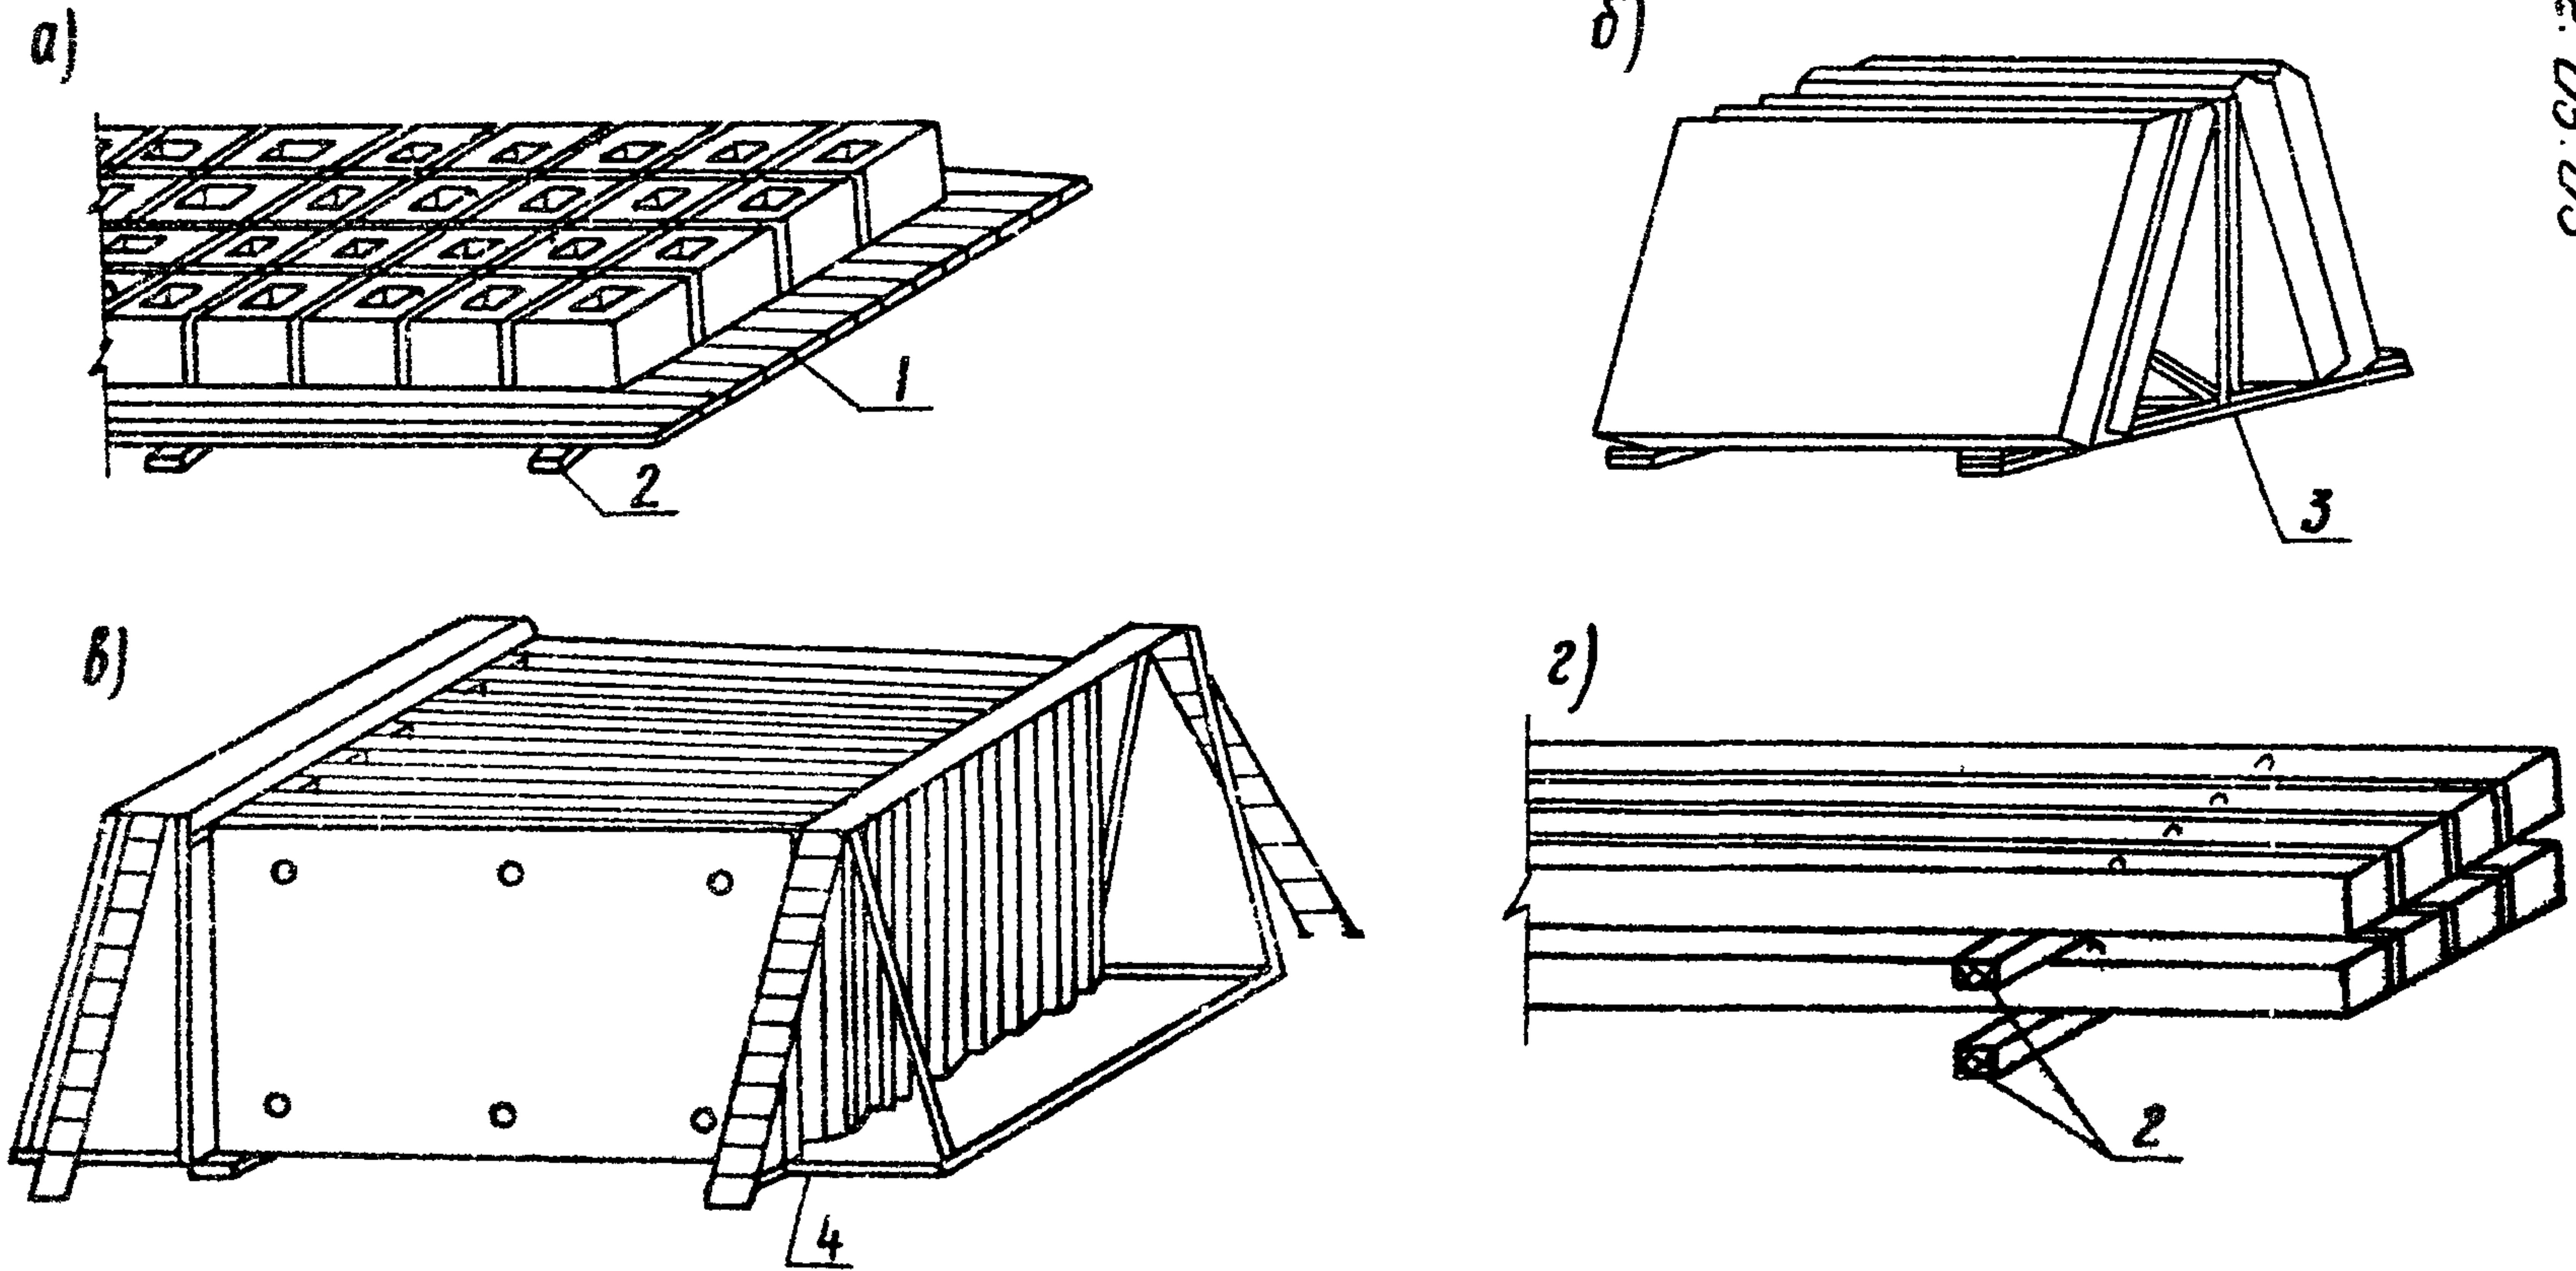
Складирование сборных конструкций: а) отоловков; б) цокольных панелей; в) панелей перекрытий; г) ростверков и балок. 1-настил из досок 40мм; 2-подкладка 80х80мм; 3-металлическая пиранида на 4 цокольные панели; 4-хассета конструкции Гипрооргсельстрой
